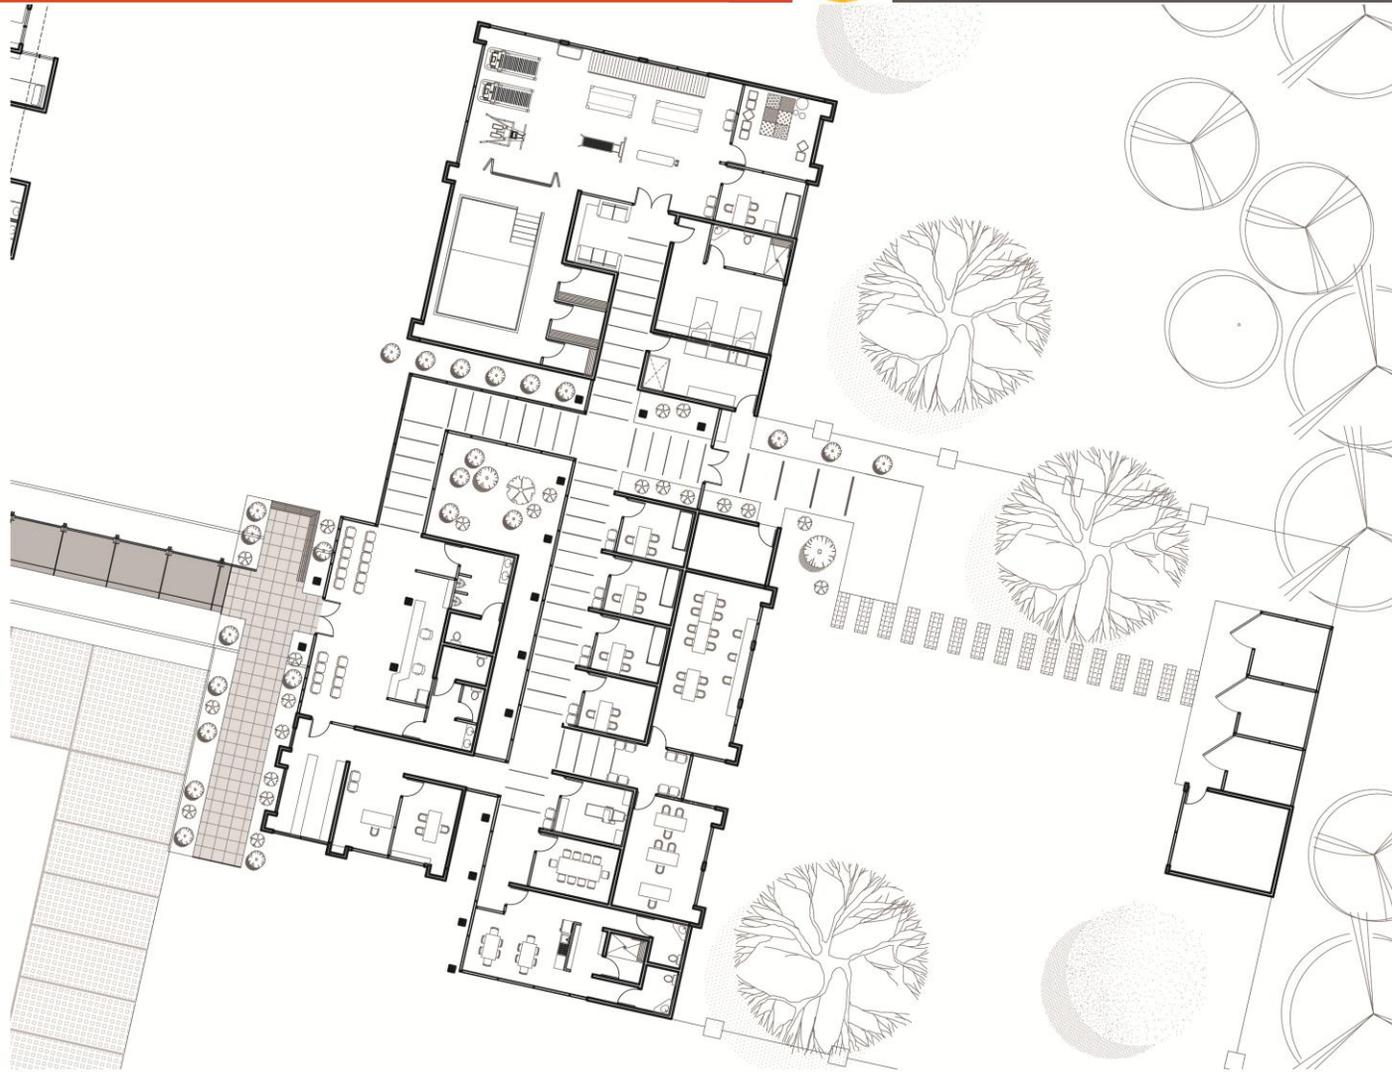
Planta del espacio Salud y Rehabilitación. Sin escala. Fuente: Elaboración propia
